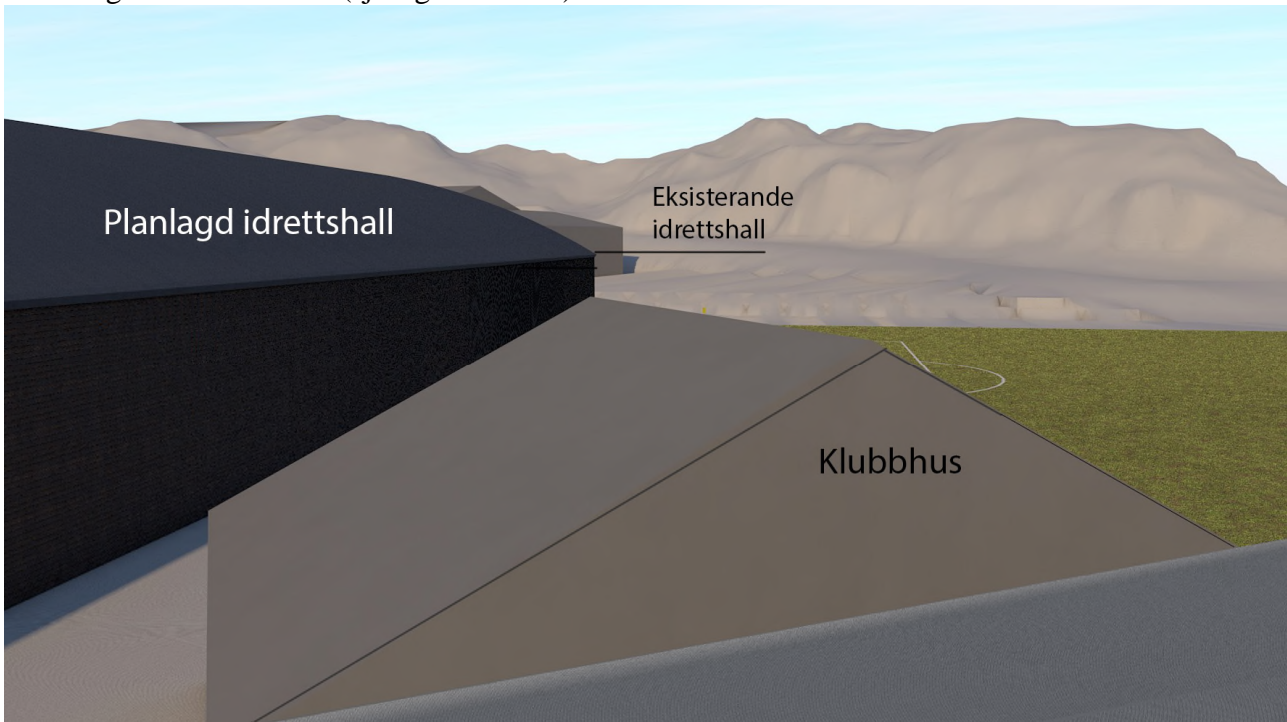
Same utsikt med planlagd idrettshall (og støyskjerm).
